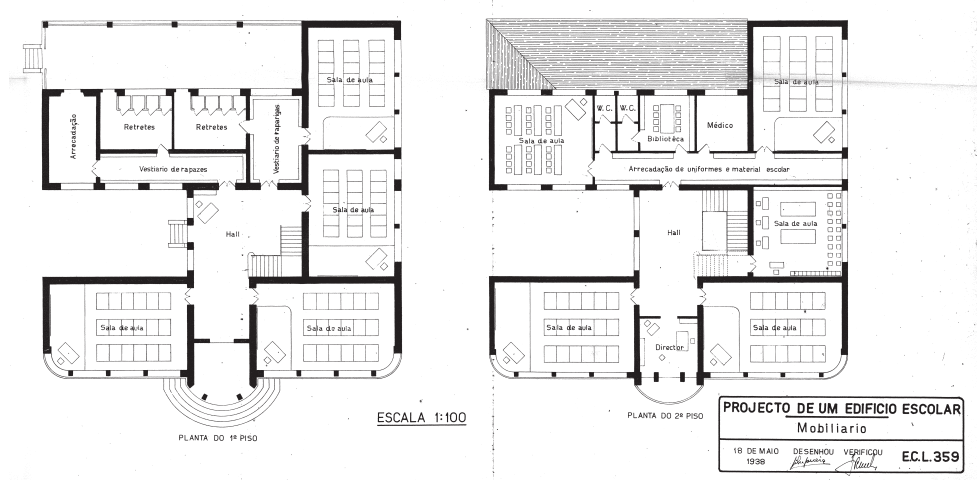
Planta 1º e 2º piso da Escola Primária, 1938
